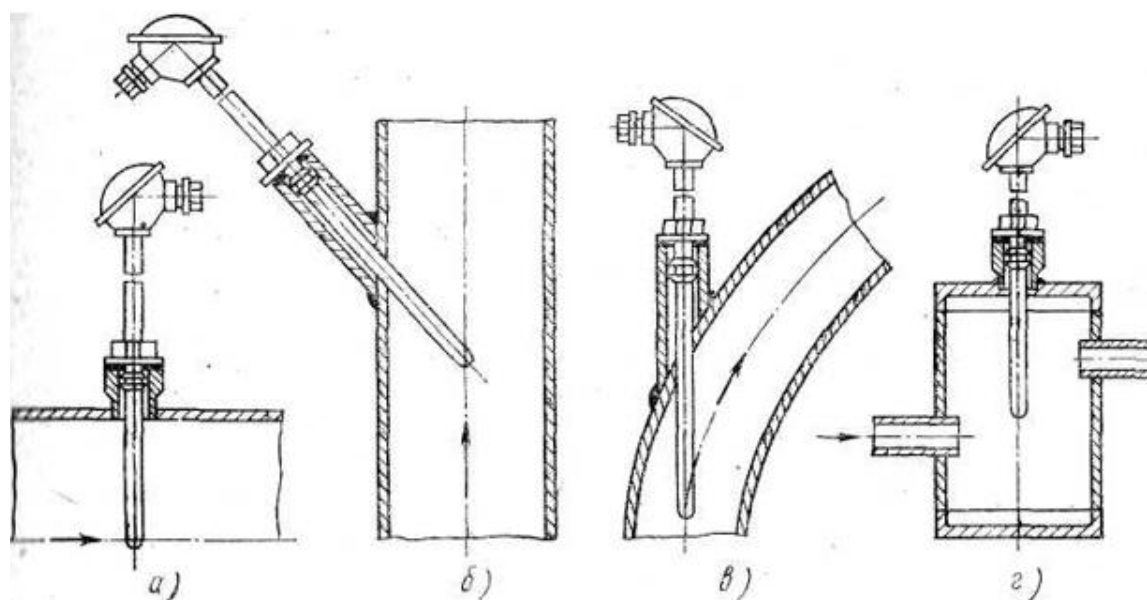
Установка термоперетворювачів опору на трубопроводах:
